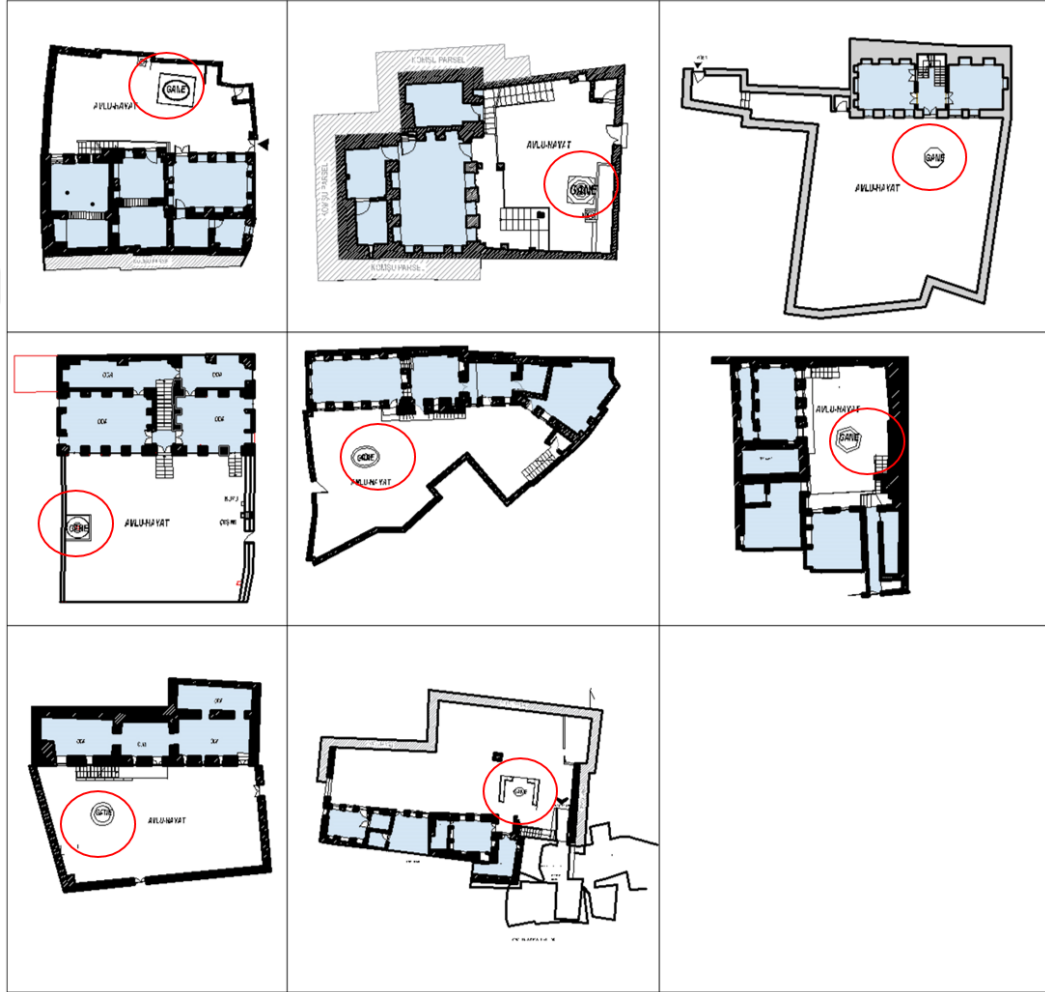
Yapı-sokak-avlu bağlantısını gösteren plan tipolojisi ve örnekleri (Dik, 2006'dan yararlanılarak düzenlenmiştir.)
